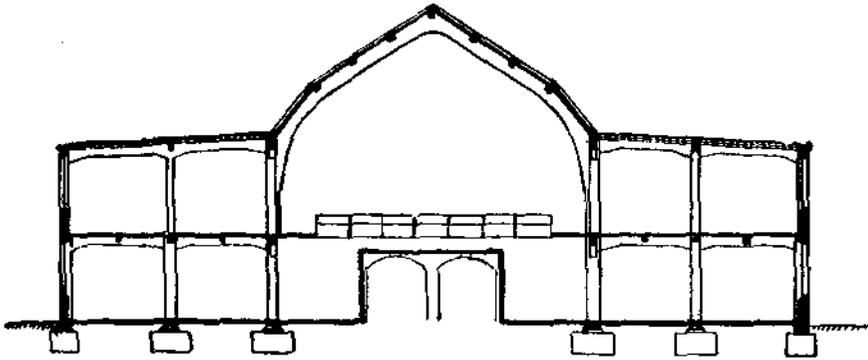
План здания фарфоровой фабрики Лангенталь в Германии.
